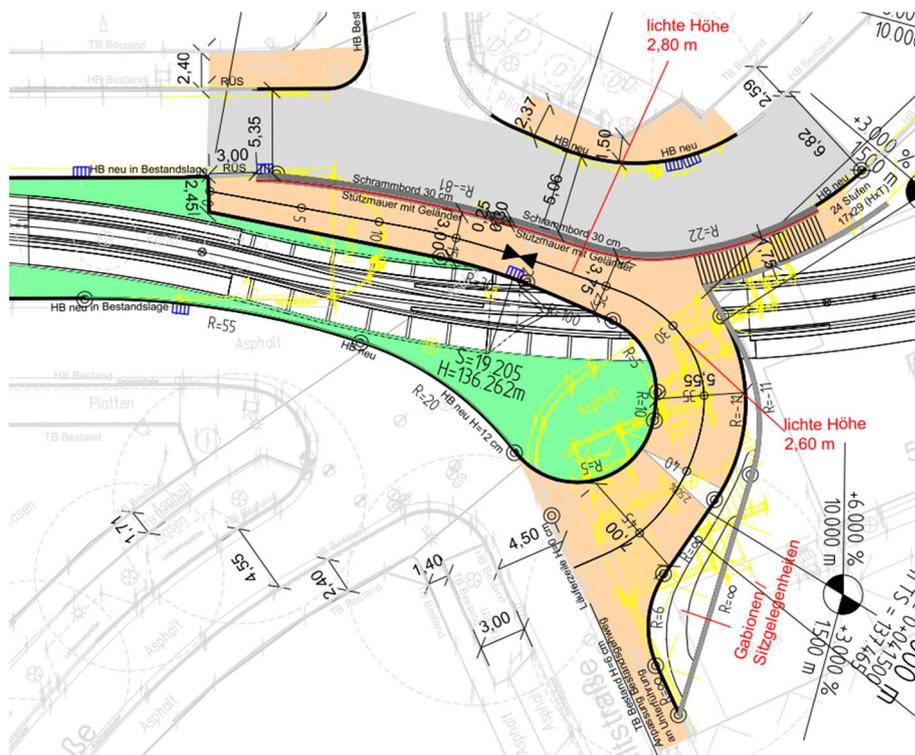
Planausschnitt Bereich Unterführung (Anlage 4, Plan-Nr. 4206)
